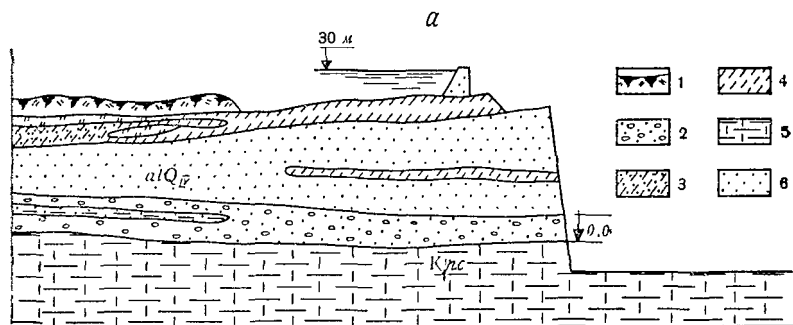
К расчету дренажа в совершенном котловане:
